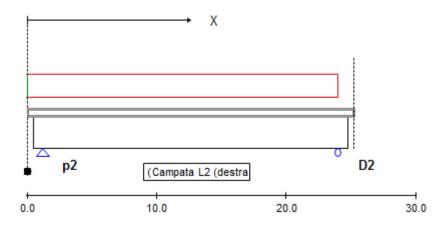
Treno di carico SW2: massimizzazione carico verticale sulla spalla
